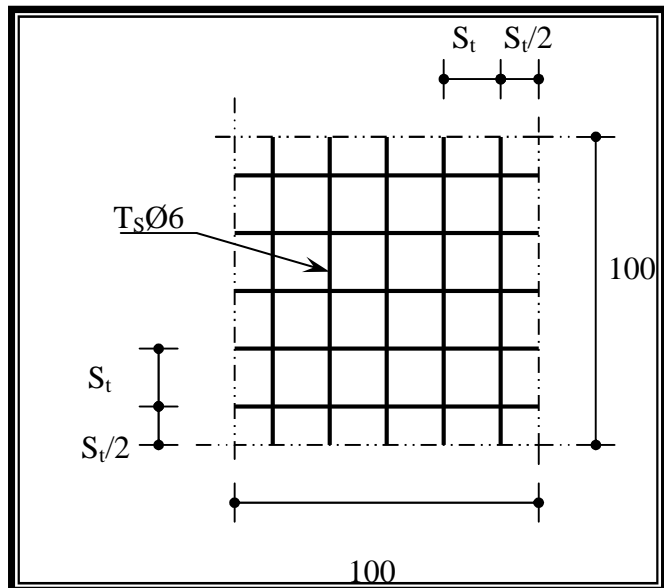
Disposition constructive des armatures de la dalle de compression
